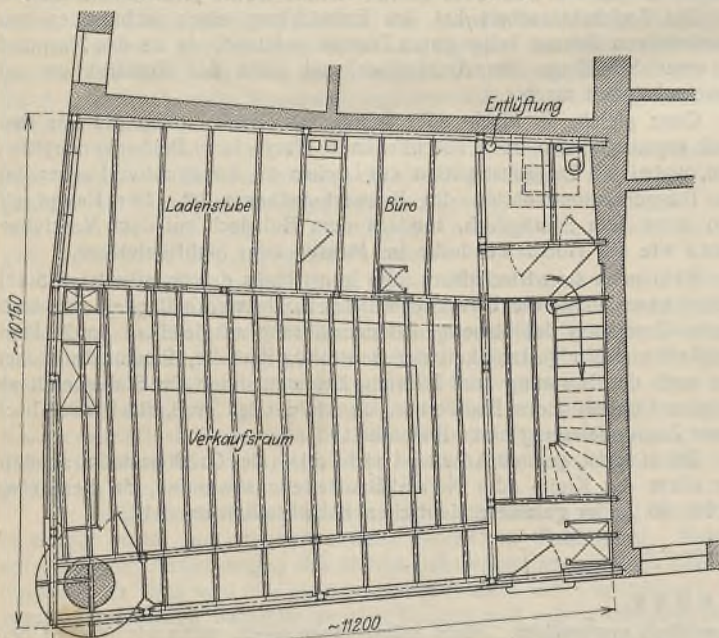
Erdgeschoßgrundriß mit Trägerlage des I. Stockwerks.
